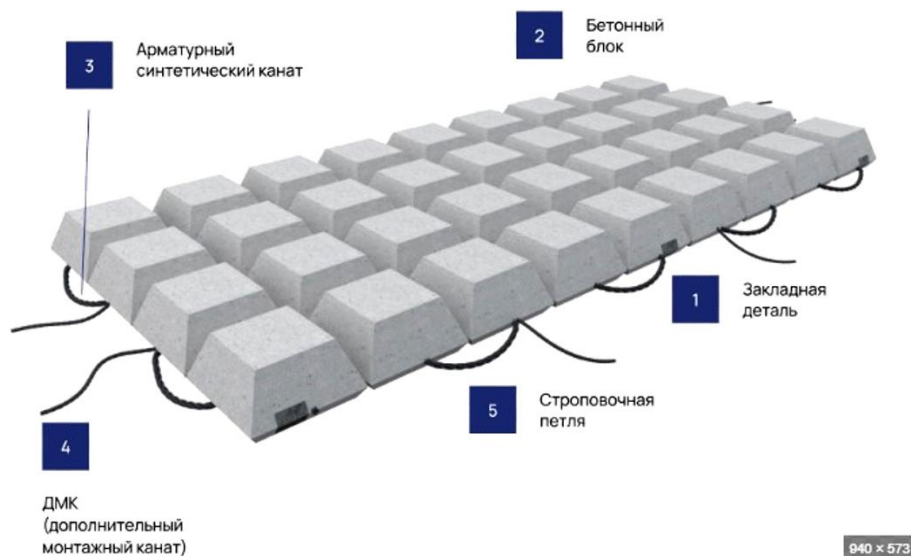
Гибкое бетонное покрытие (источник фото электронный ресурс Википедия: Гибкое бетонное покрытие)
